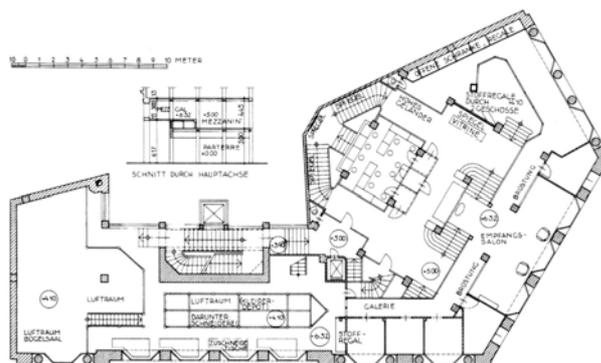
Edifício Michaelerplatz, Adolf Loos, planta do térreo
